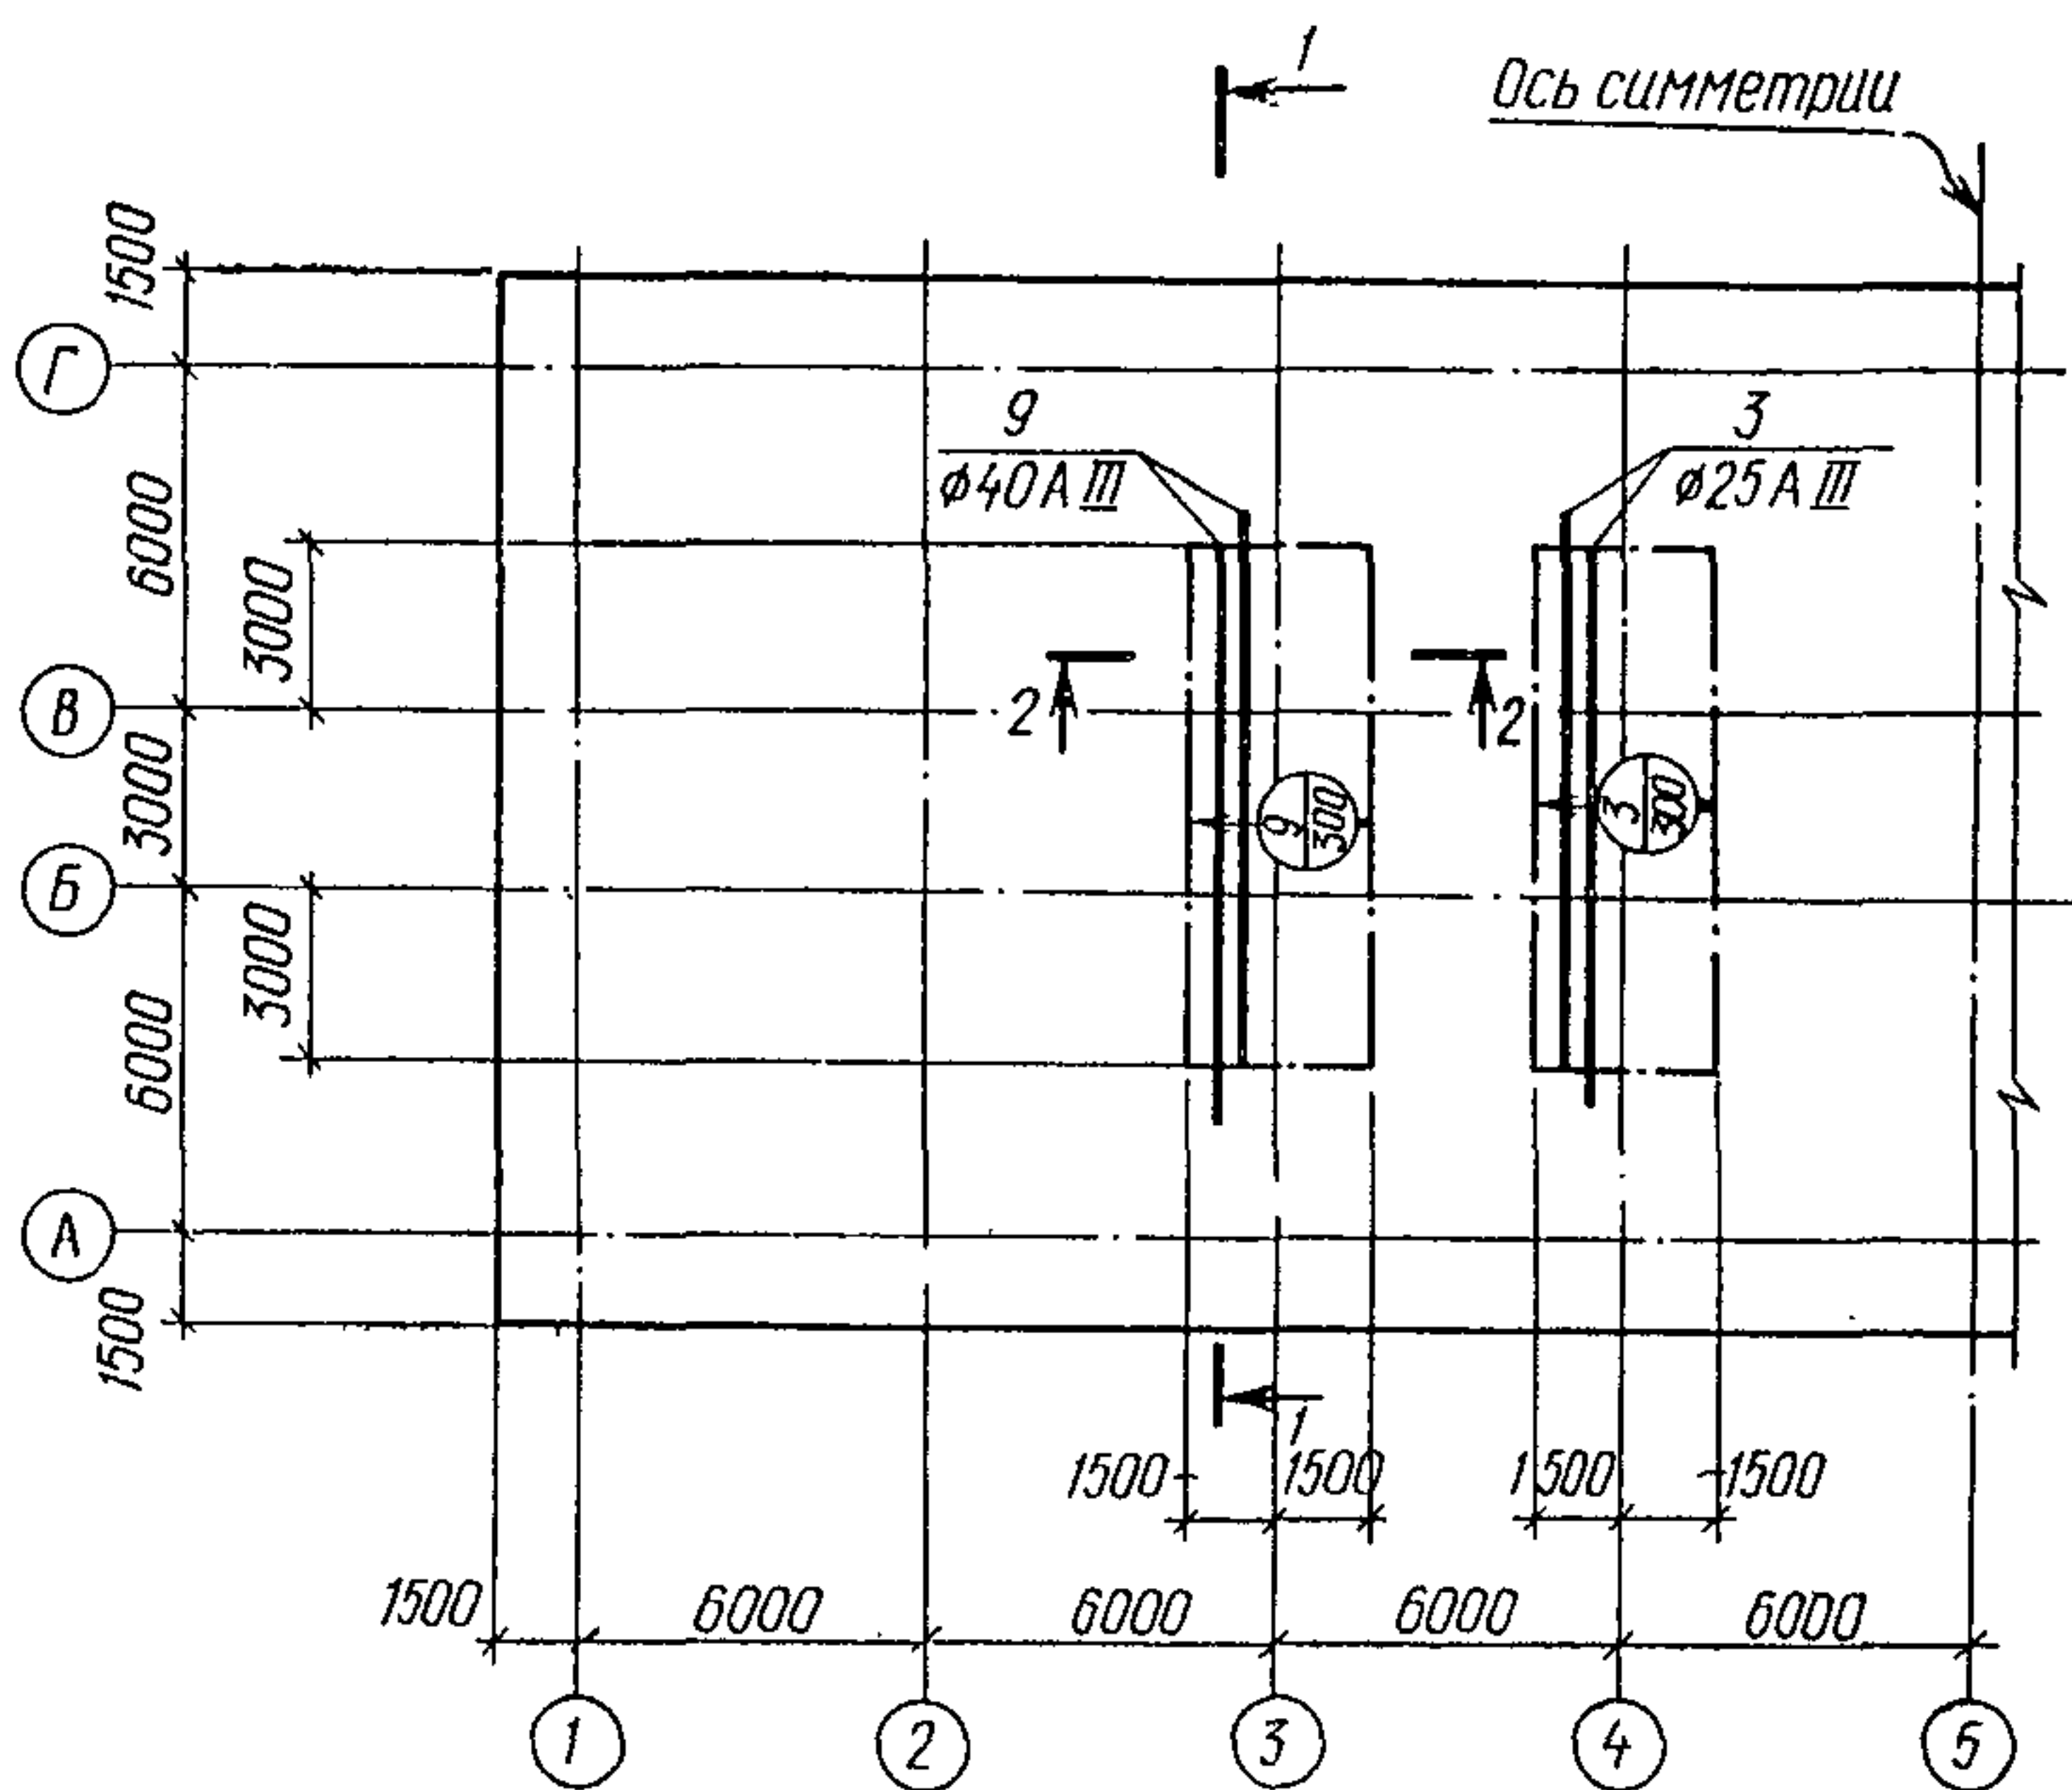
План раскладки арматуры третьего слоя нижней зоны
